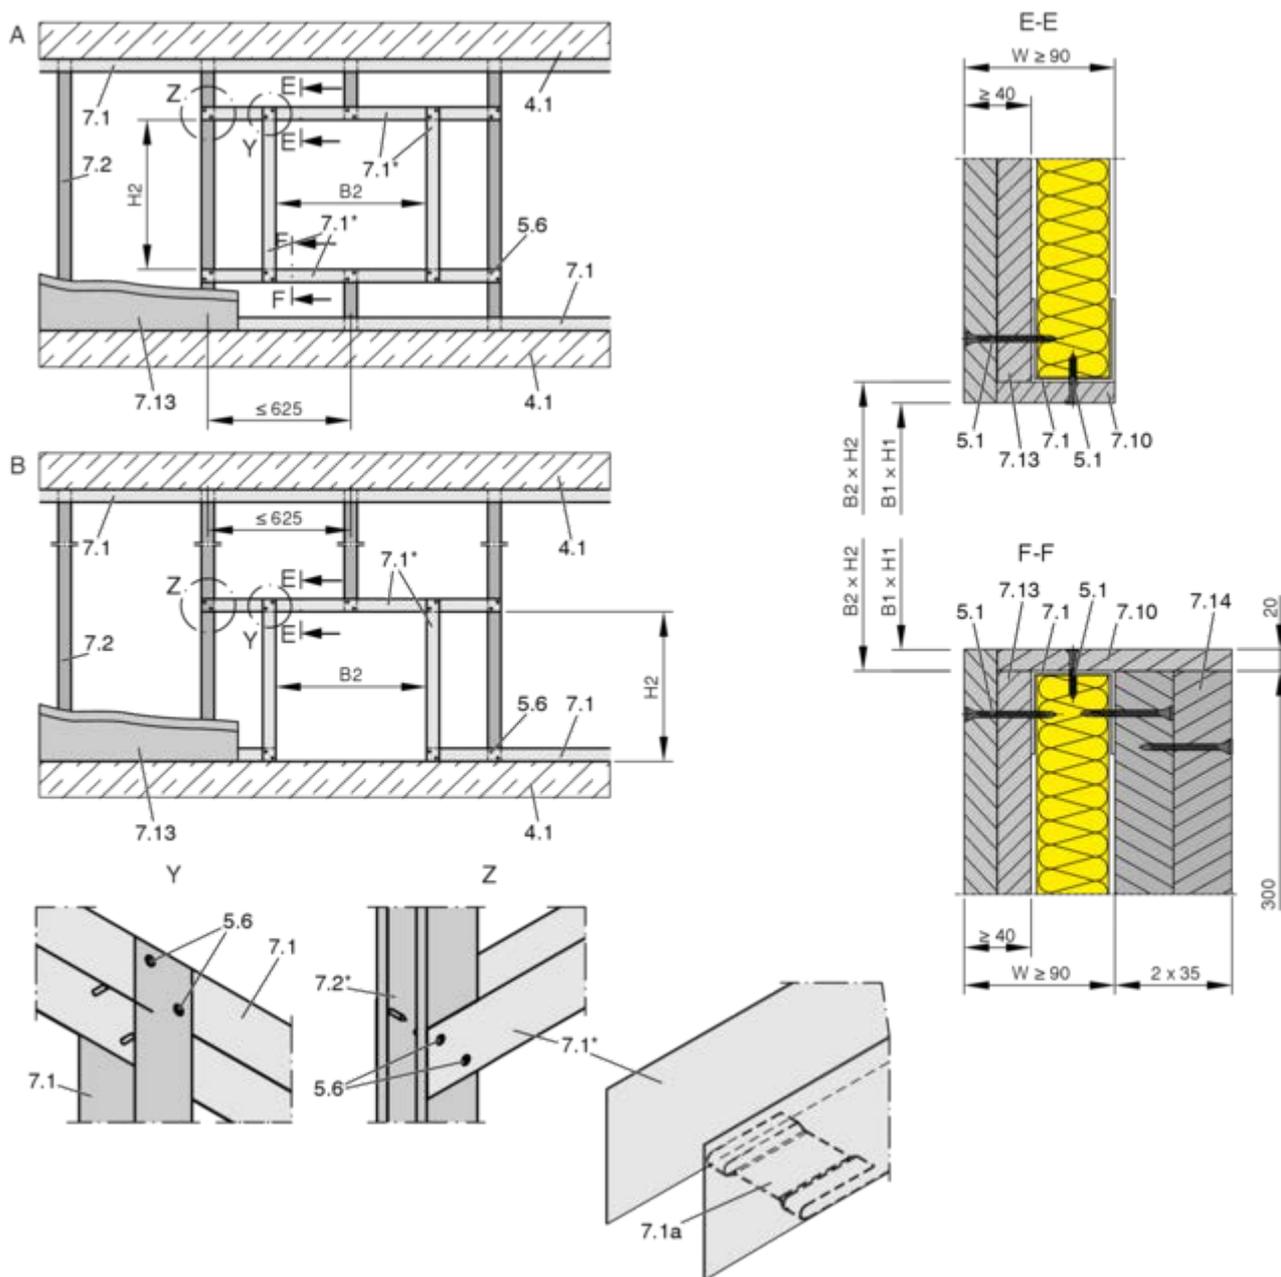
Parede de caixa com estrutura de apoio de metal e revestimento num dos lados (vistas detalhadas mostradas como exemplo para $W = 90 \text{ mm}$)
